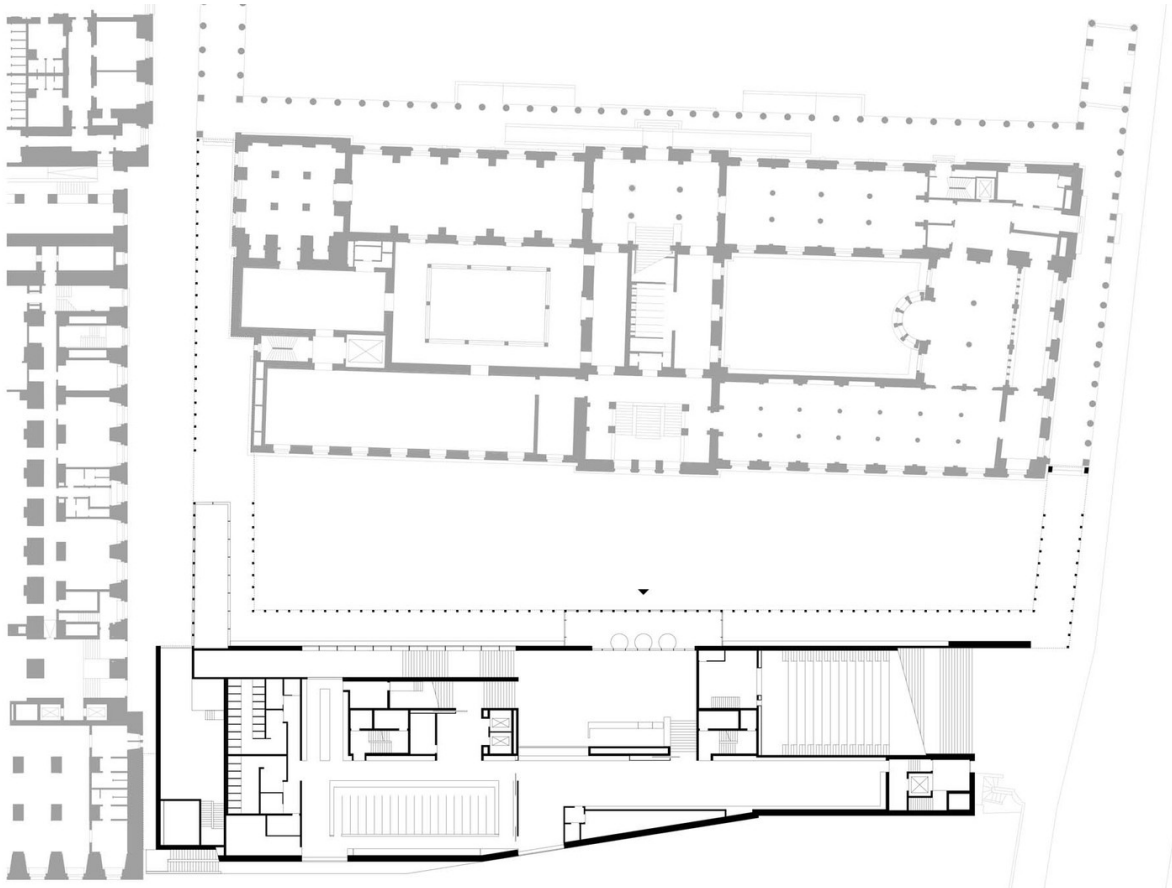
Planta urbana del James Simon Galerie. Fuente: Archdaily
